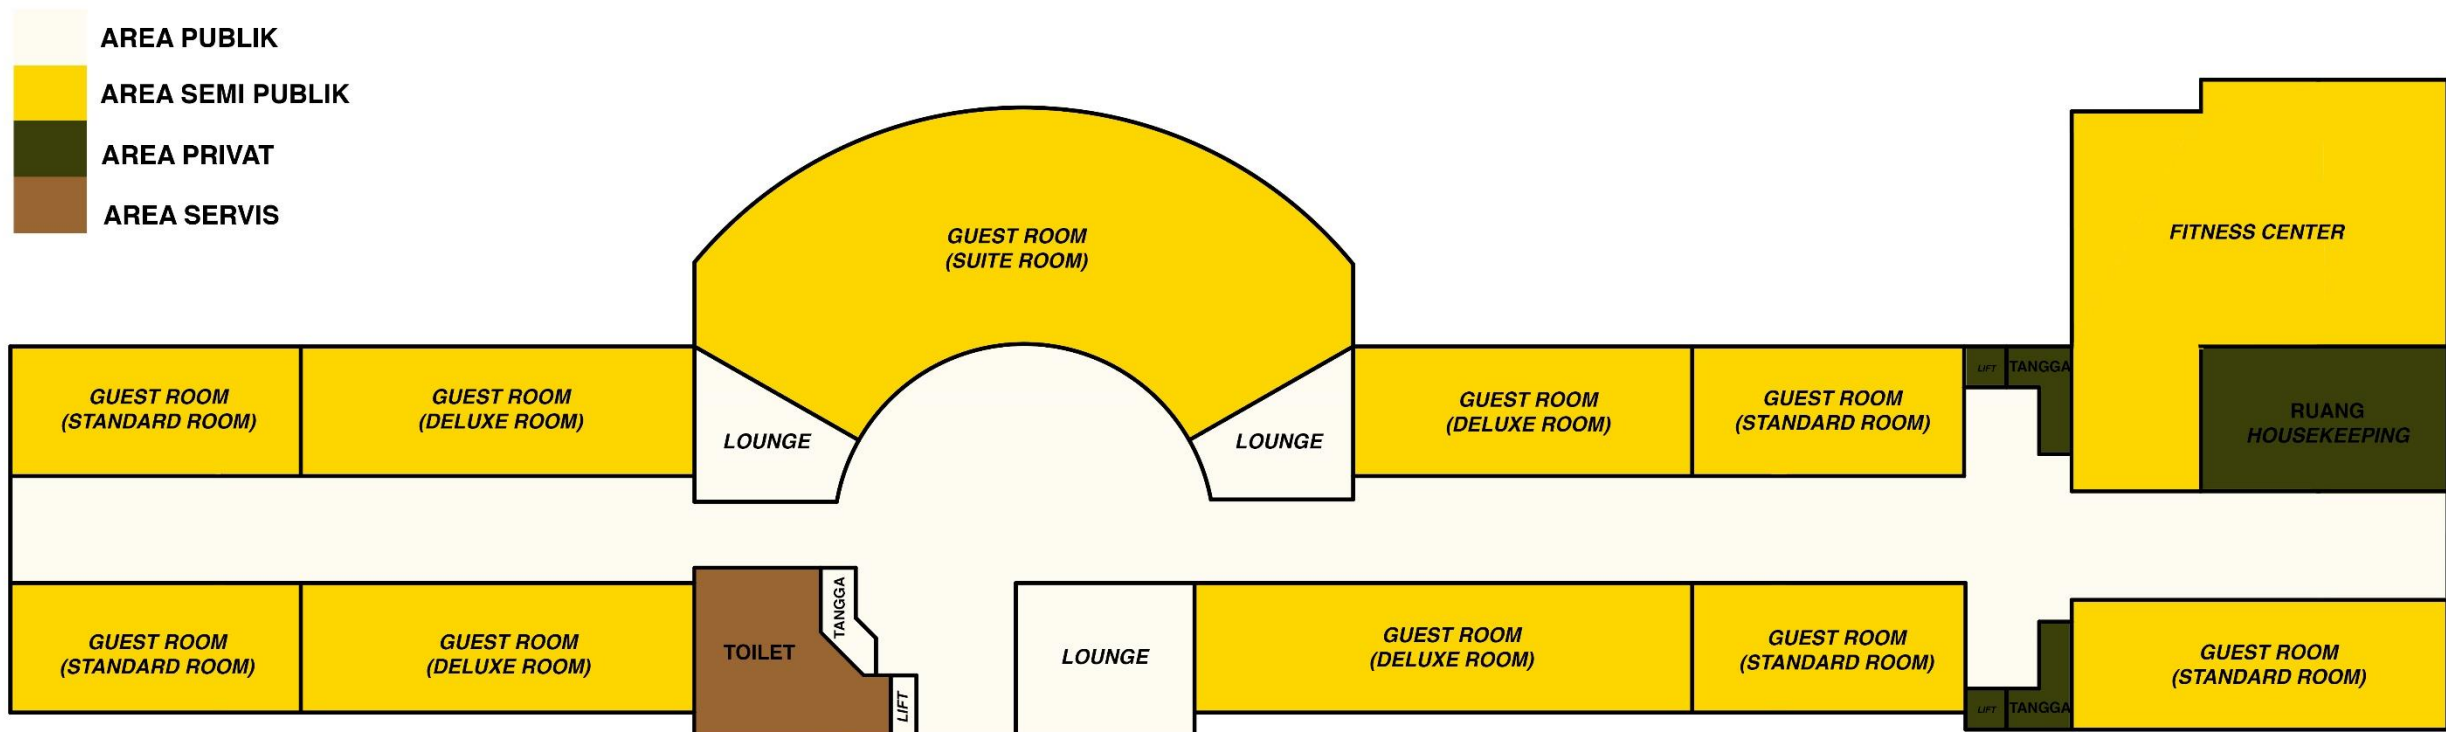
Alternatif 1 *Grouping Zoning* Lantai 1
